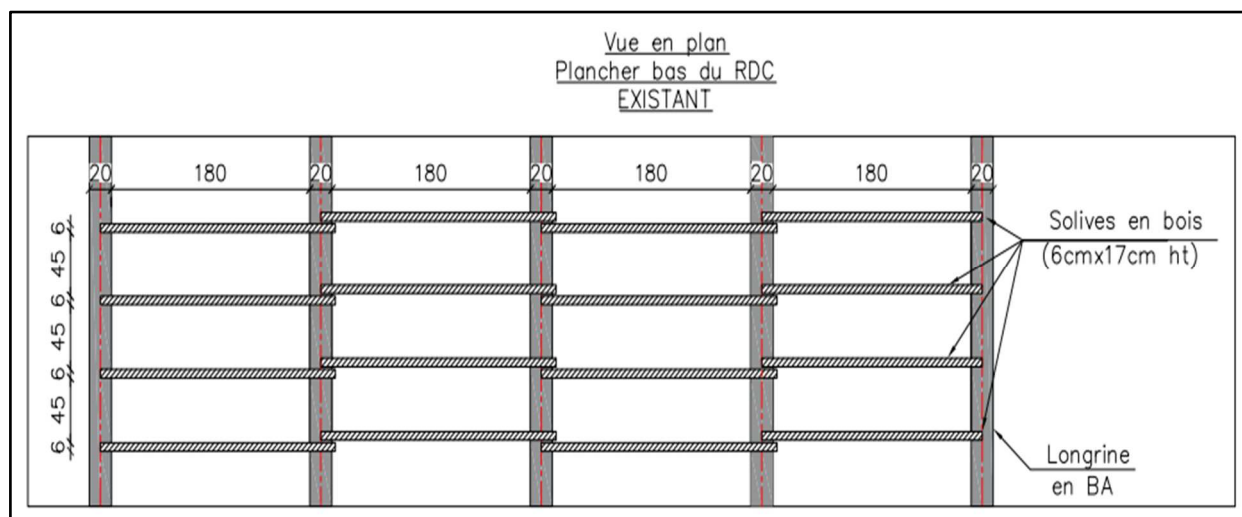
Vue en plan du plancher bas du RDC EXISTANT
